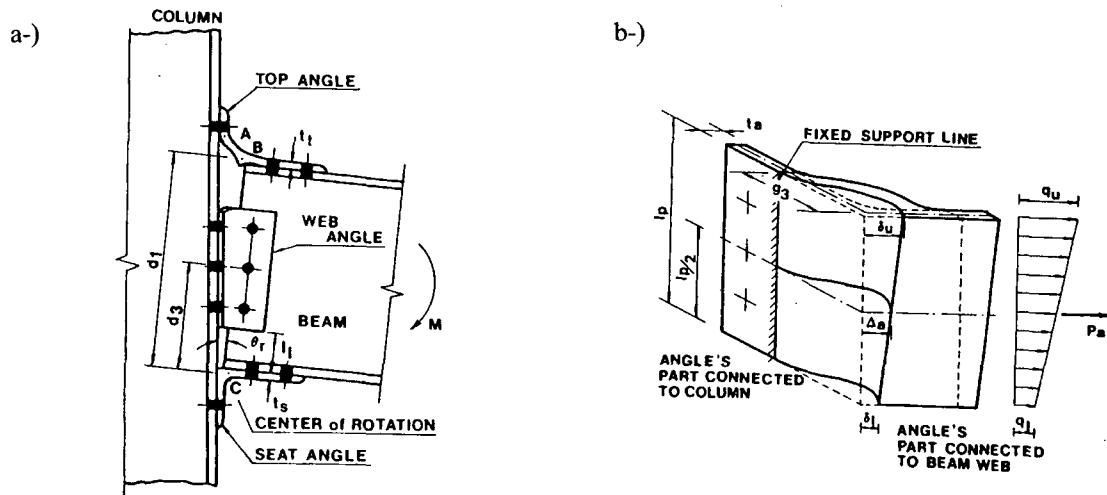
Configuração de deformação das cantoneiras conectadas na viga e coluna no regime elástico e a configuração deformada do modelo de cantilever para a conexão “Web Angle”, retirado de Kirby et al.(1990).
